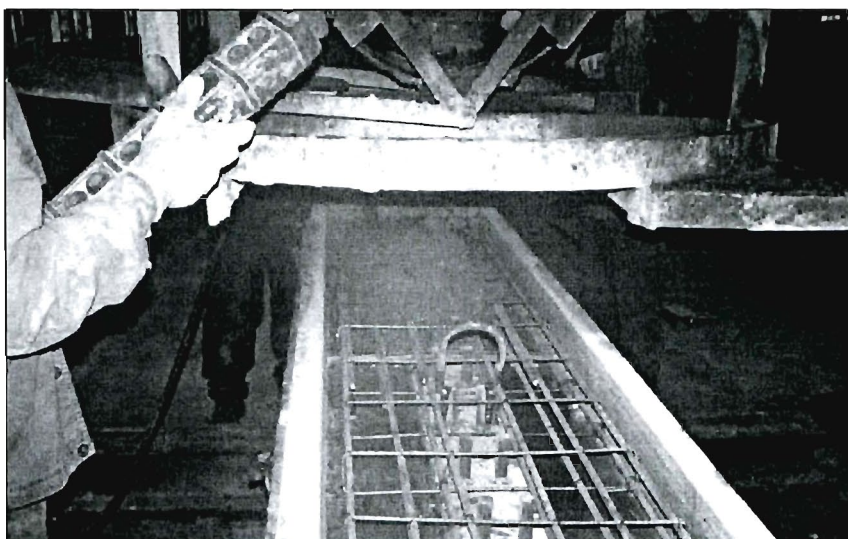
Element badawczy przygotowany do betonowania płyty
